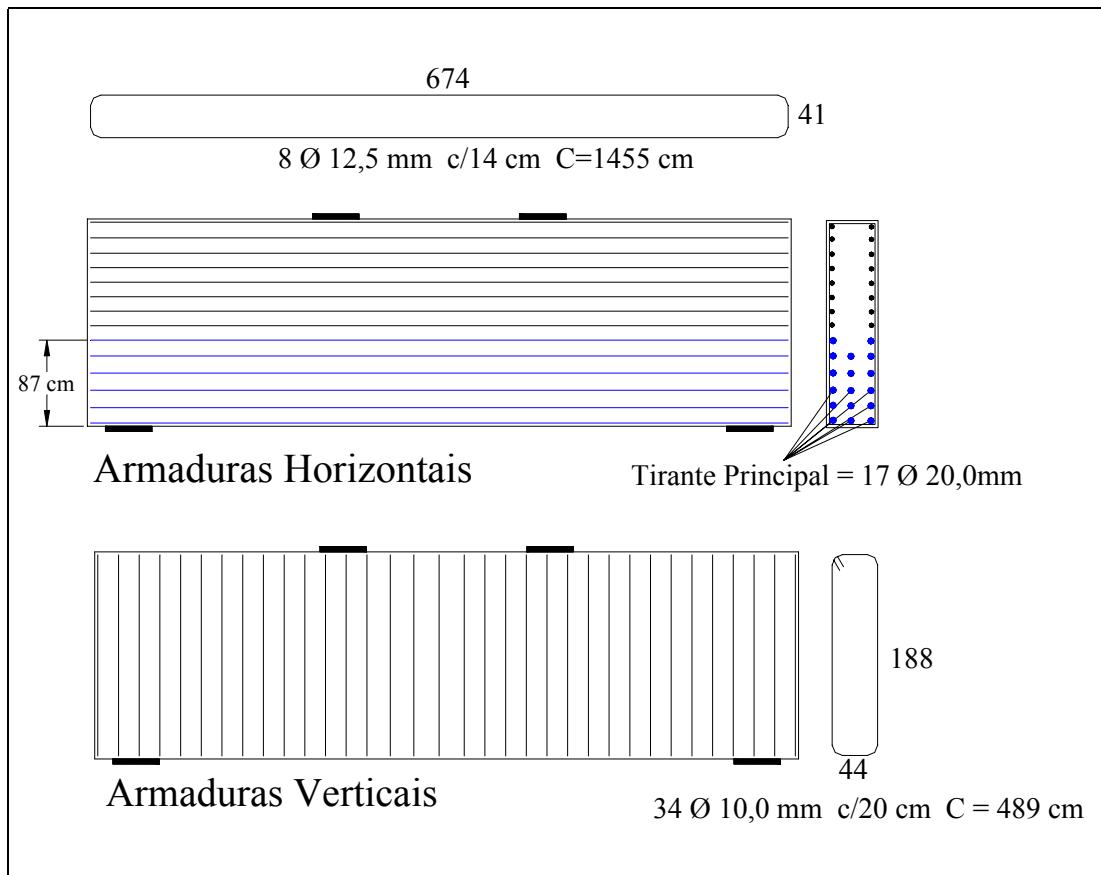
Detalhamento de armaduras obtido para a viga-parede utilizando o MEF
